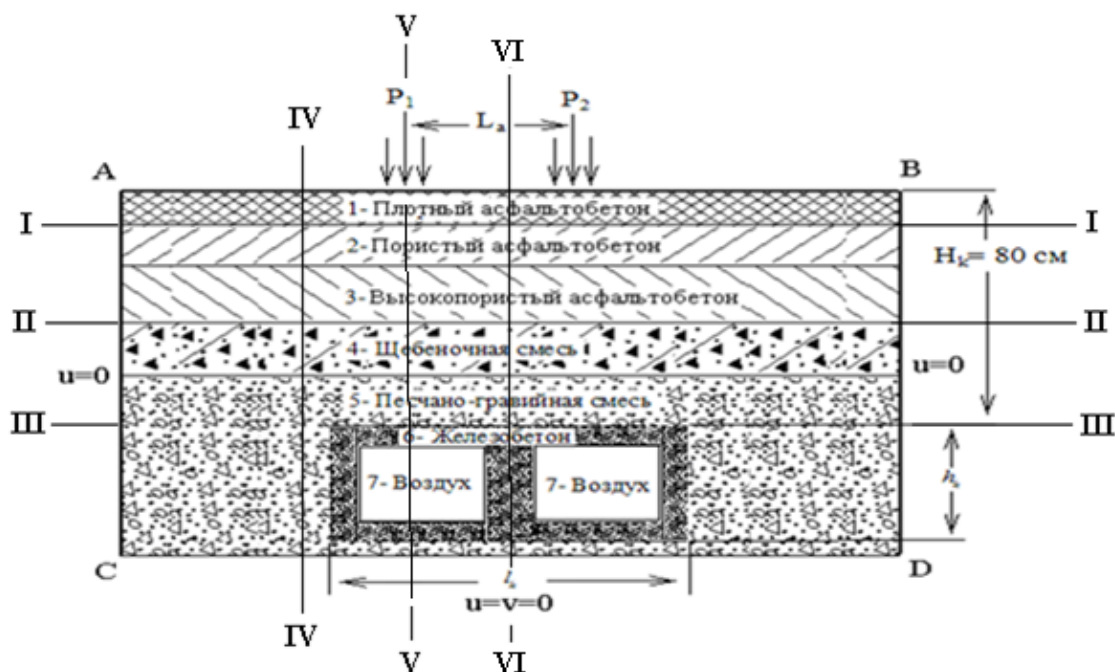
Схематический вид дорожной конструкции: 1 – плотный асфальтобетон; 2 – асфальтобетон пористый; 3 – высокопористый асфальтобетон; 4 – щебеночная смесь подобранного состава; 5 – песчано-гравийная смесь; 6 – железобетонные стенки подземных коллекторов; 7 – воздух внутри коллекторов; L_a – ширина колеи транспортного средства; H_k – глубина заложения железобетонных коллекторов; P_1, P_2 – нагрузки от колес транспортного средства; u, v – компоненты перемещения точек на границах в направлении координатных осей x и y соответственно
